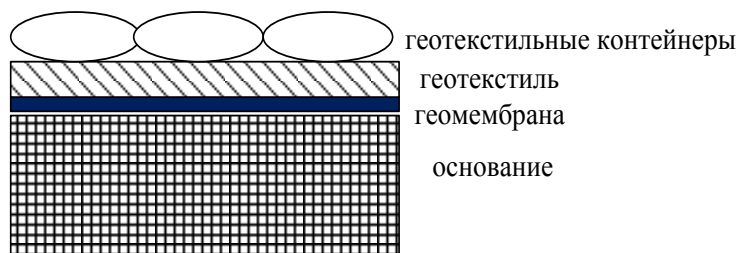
Возможный вариант исполнения гидроизоляционного экрана площадки под размещение геотекстильных контейнеров
